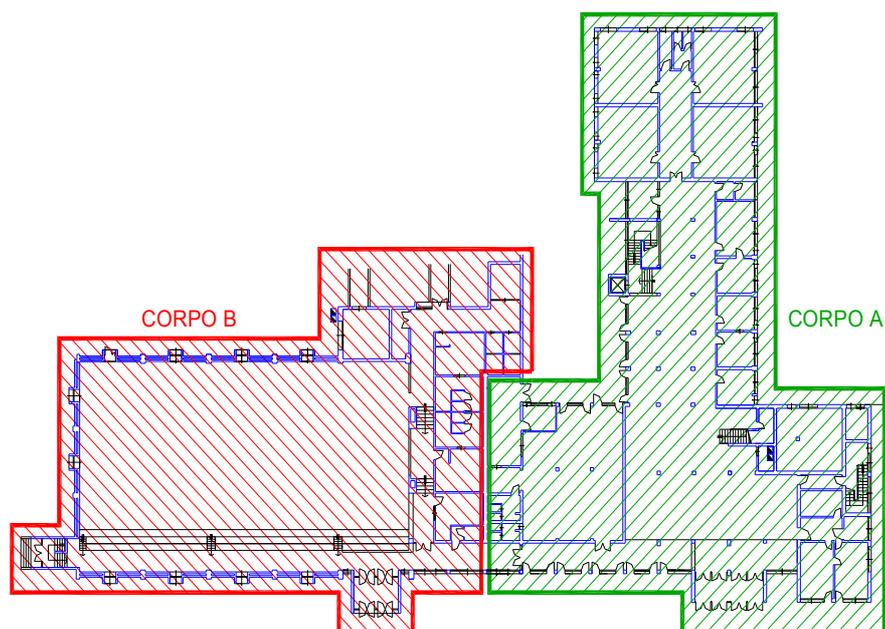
Planimetria del Plesso Scolastico ed individuazione delle unità strutturali.
